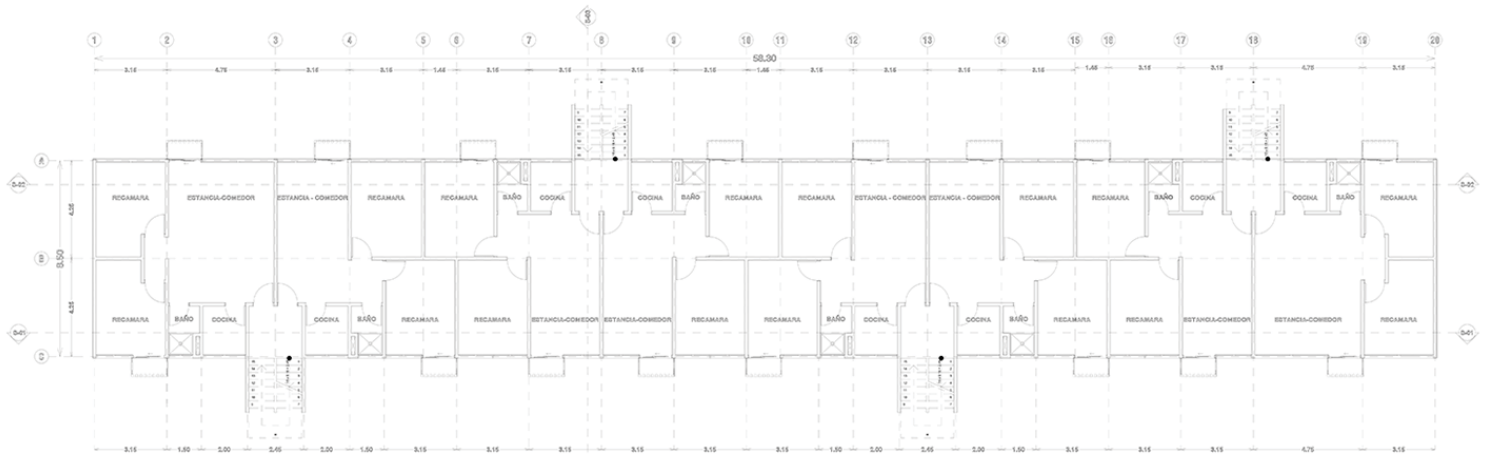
Planta edificio 2A .obras.cdmx.gob.mx
